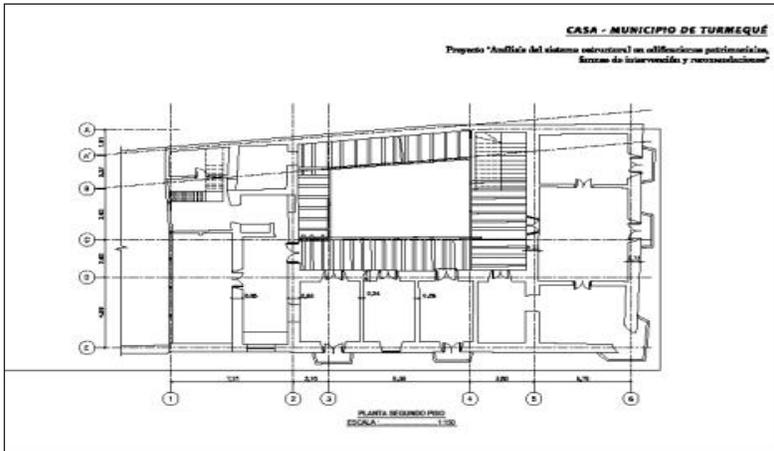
Plano de planta segundo piso. Fuente: Elaboración propia.
